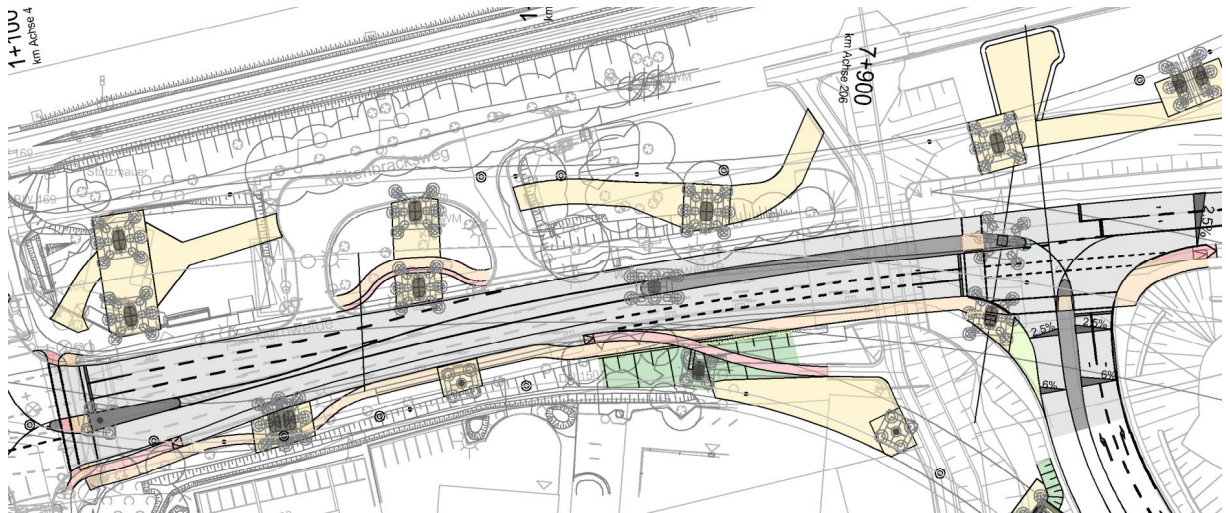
Lageplan mit Darstellung der geänderten Verkehrsführung
